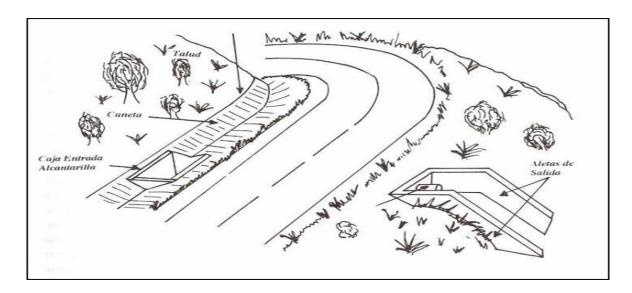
(g) Drenaje Transversal, alcantarilla atravesando la vía carretera Cortesía de Revista Digital De Ingeniería, Arquitectura, Ciencia y Tecnología
